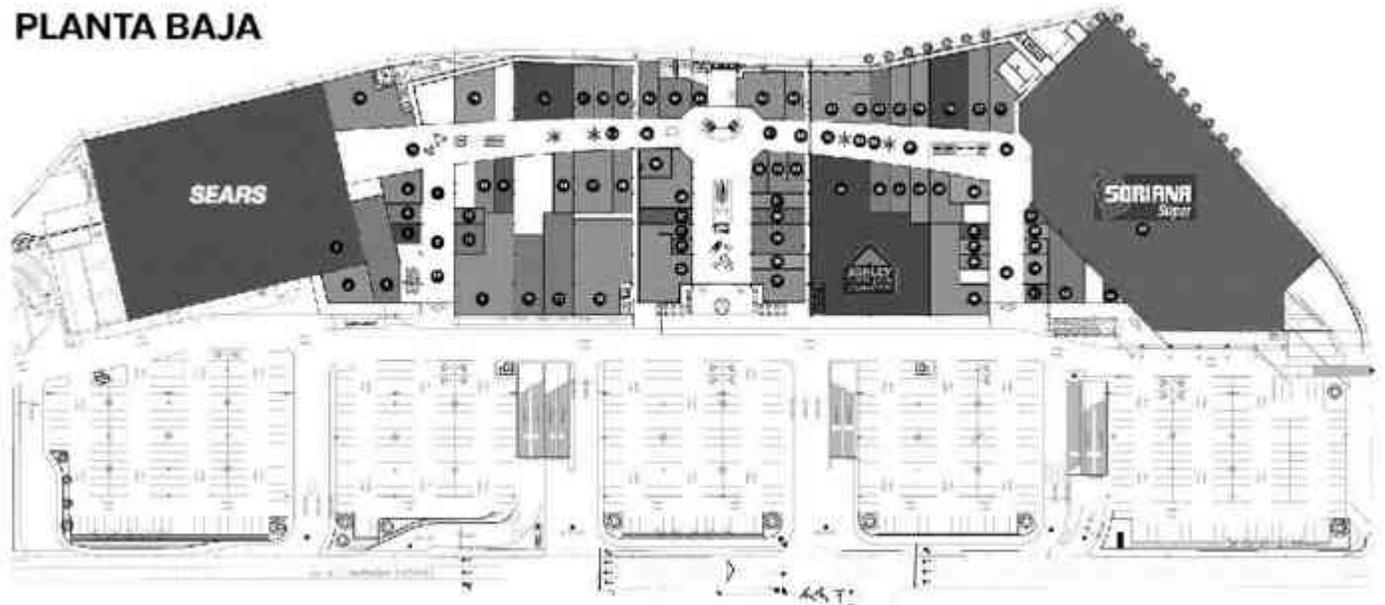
Planta baja de la Plaza Comercial San Agustín, Monterrey, Nuevo León. Foto. . (<http://www.pfsanagustin.com.mx/>)
